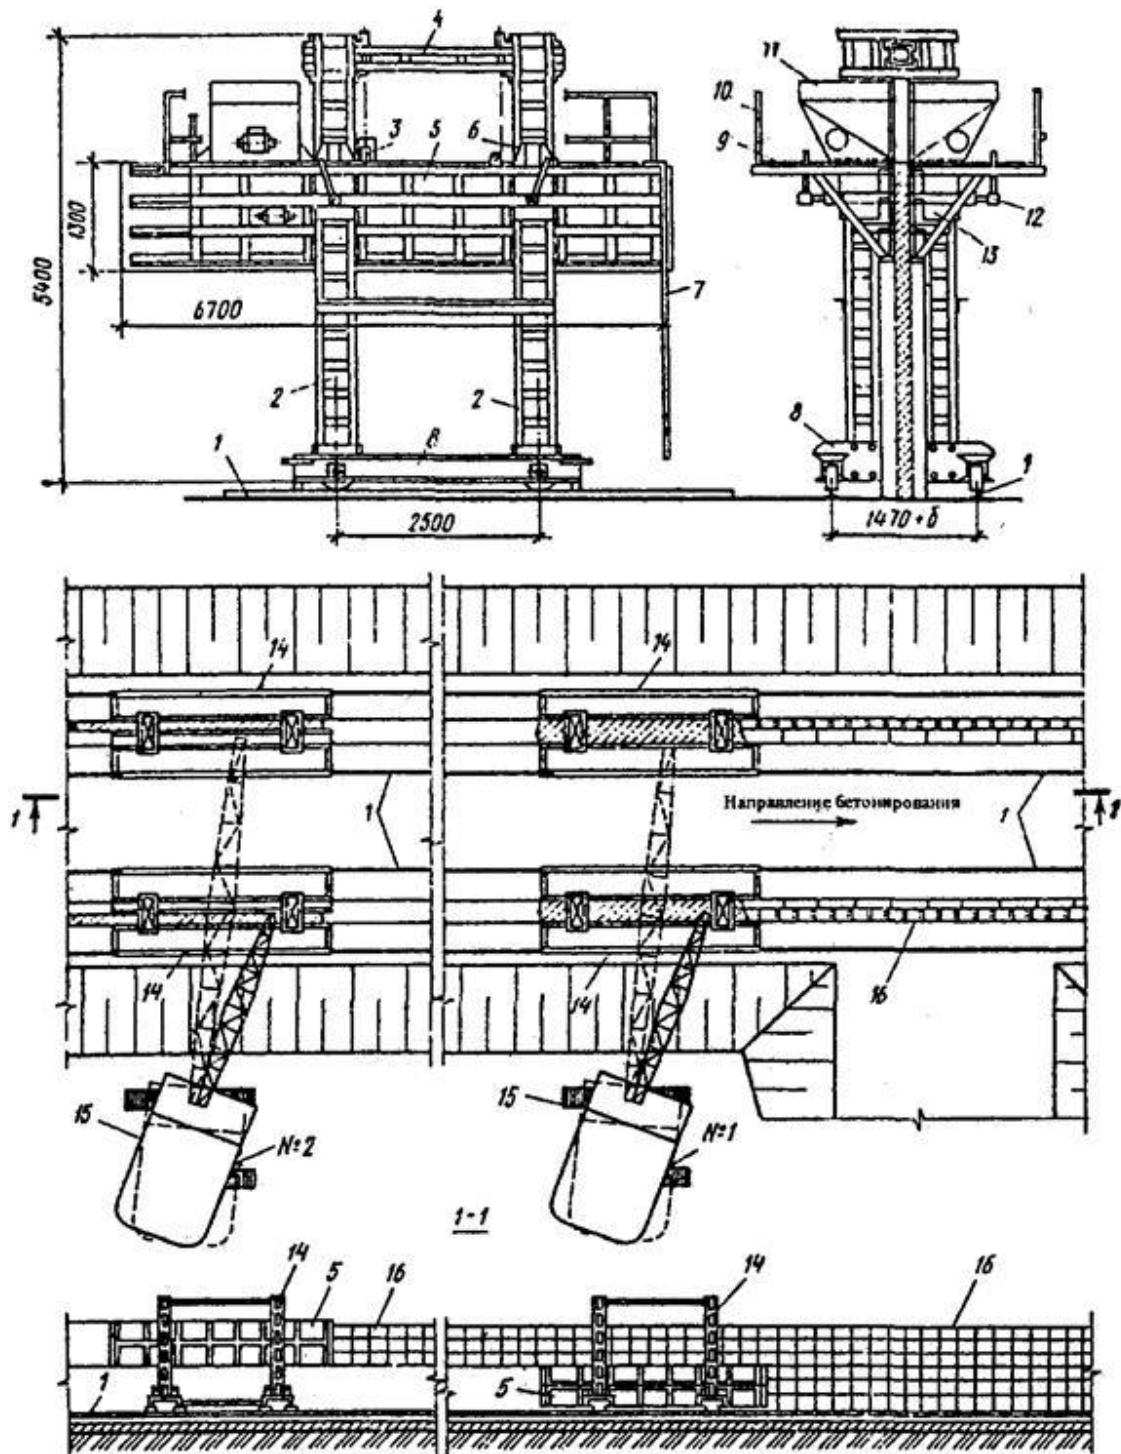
Бетонирование стен прямоугольных отстойников с помощью горизонтально-скользящей опалубки:
